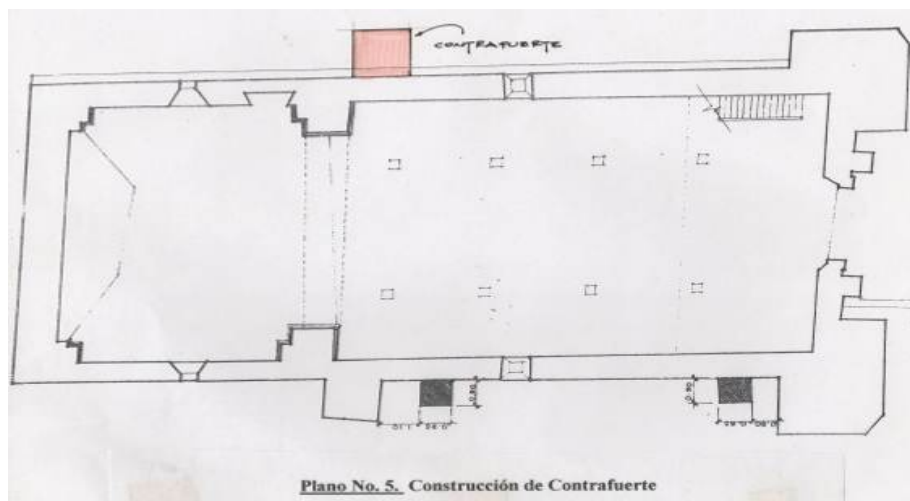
Plano de planta del templo con indicación de la construcción de contrafuerte. (Quiñónez, 2002)
